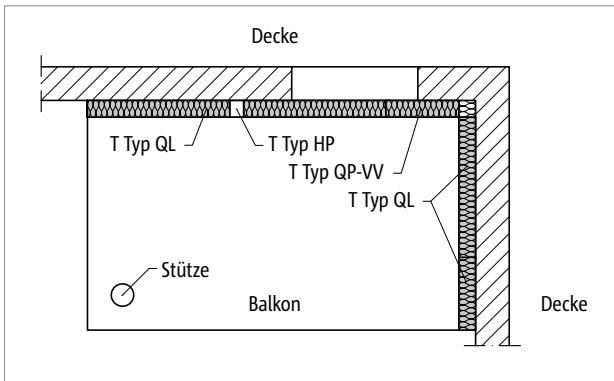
Schöck Isokorb® XT Typ QL, QP-VV: Balkon zweiseitig gelagert mit Stütze und abhebenden Querkraften
